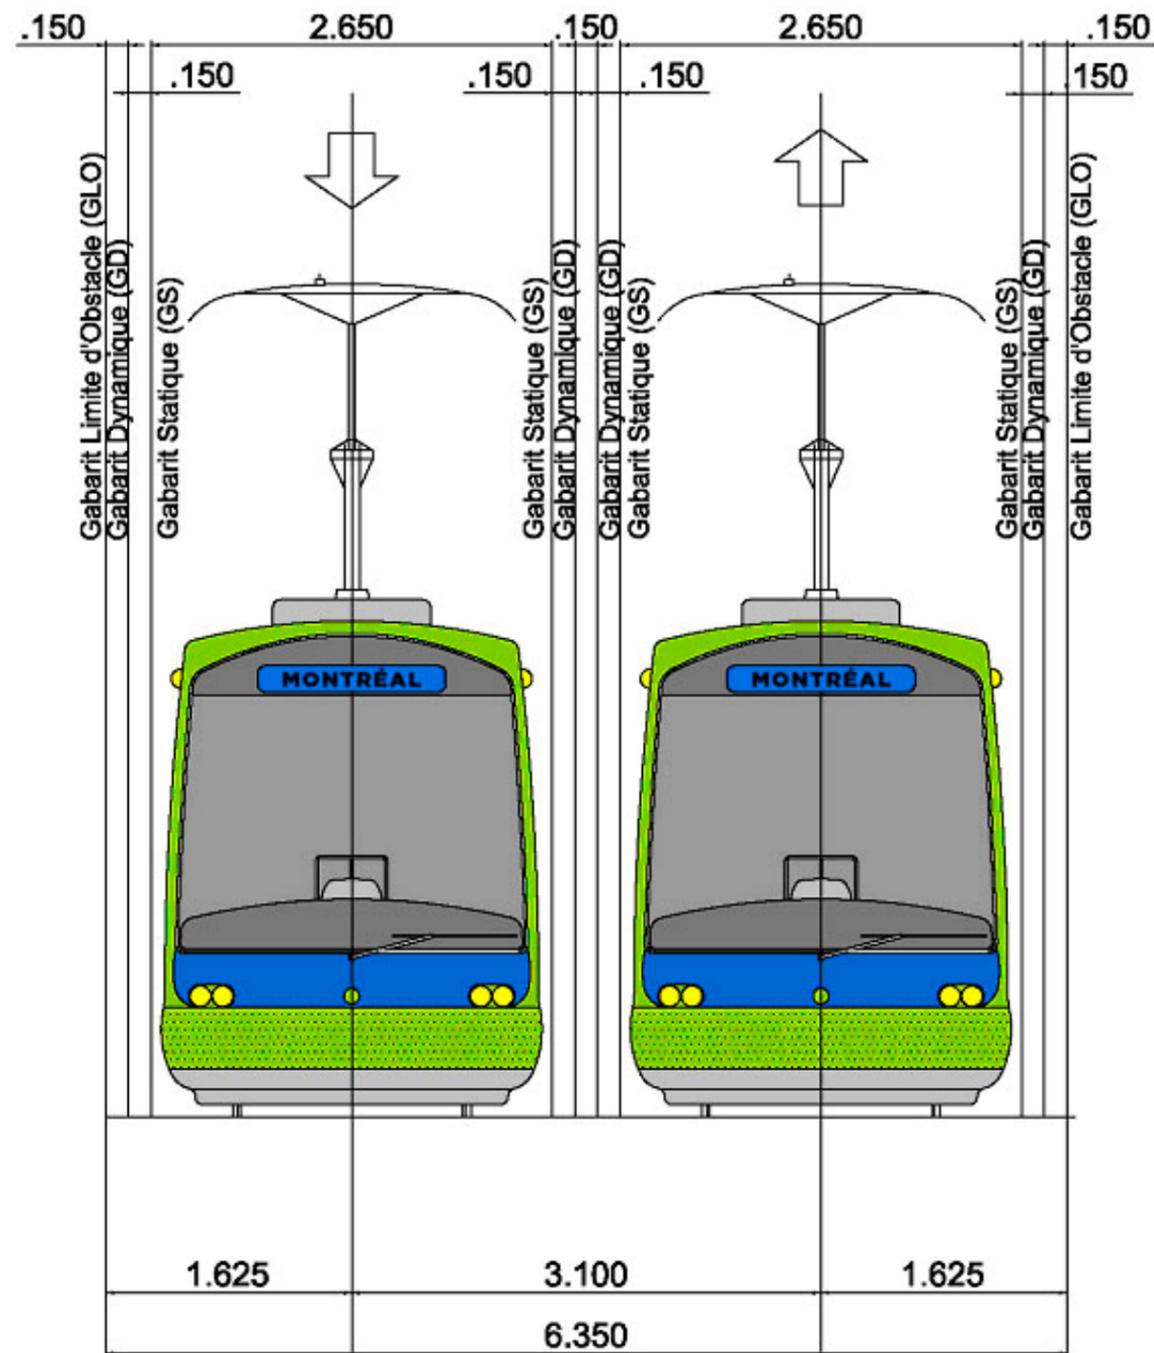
Voie double en alignement droit avec poteaux centraux
